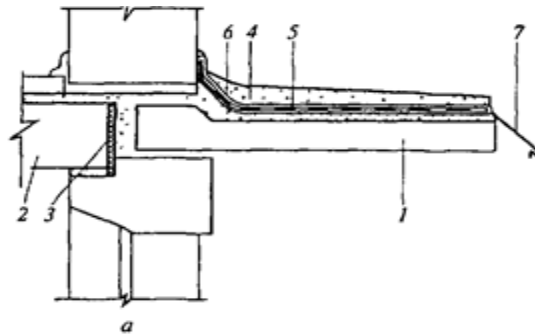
Конструкція балкону: а - із залізобетонних плит; 1 - балконна плита; 2 - плита перекриття; 3 - утеплювач; 4 цементна стяжка; 5 гідроізоляційний килим; 6-підлога; 7-стік, [25].
